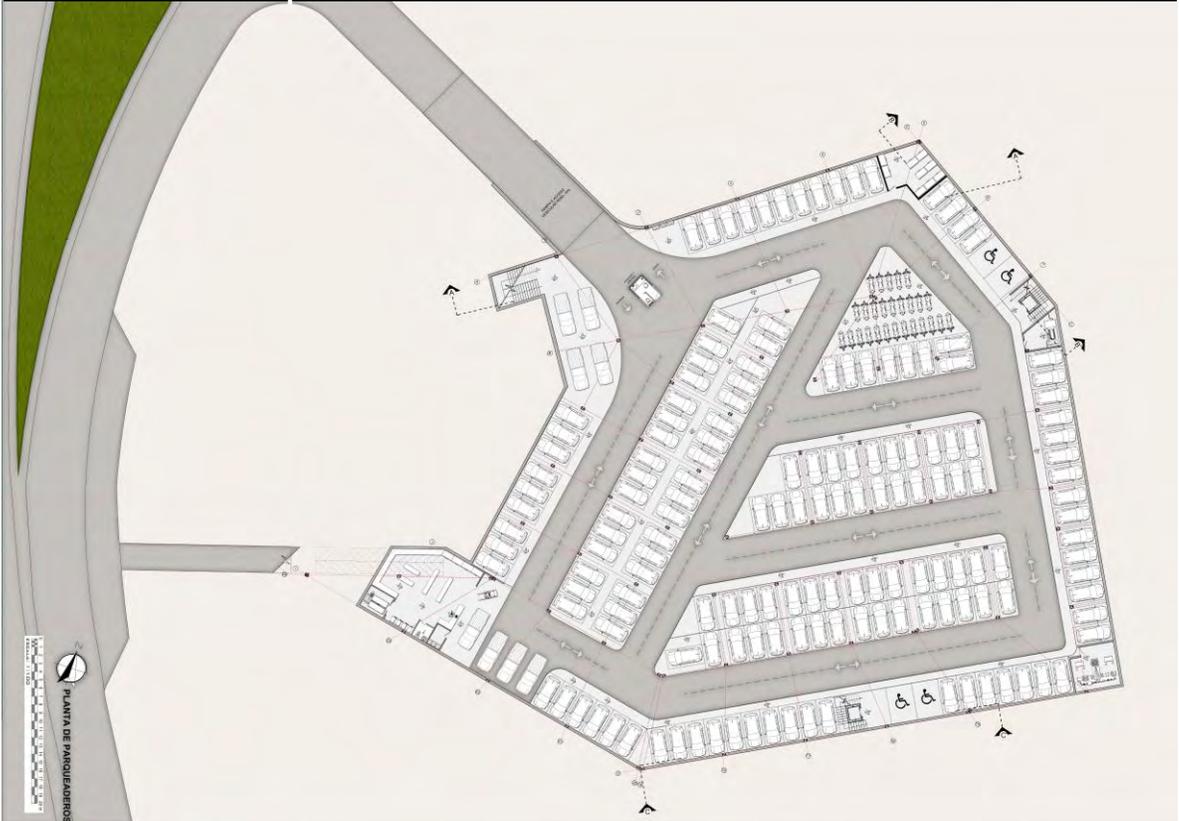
Planta de Parquederos. Fuente: Elaboración propia
